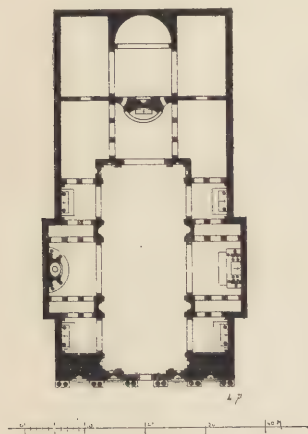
St. Maria ai Scalzi zu Venedig. Grundriss.
